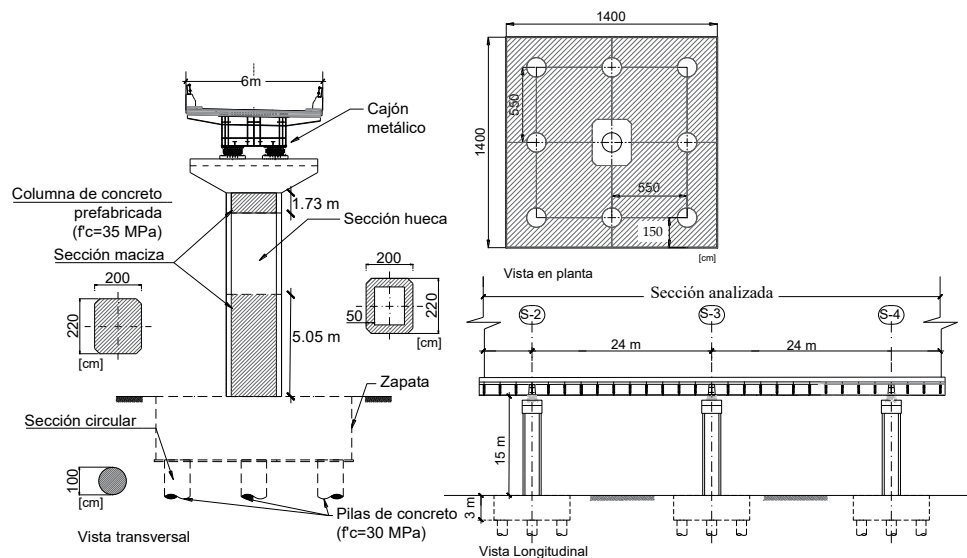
Vista transversal y longitudinal del paso elevado urbano.
